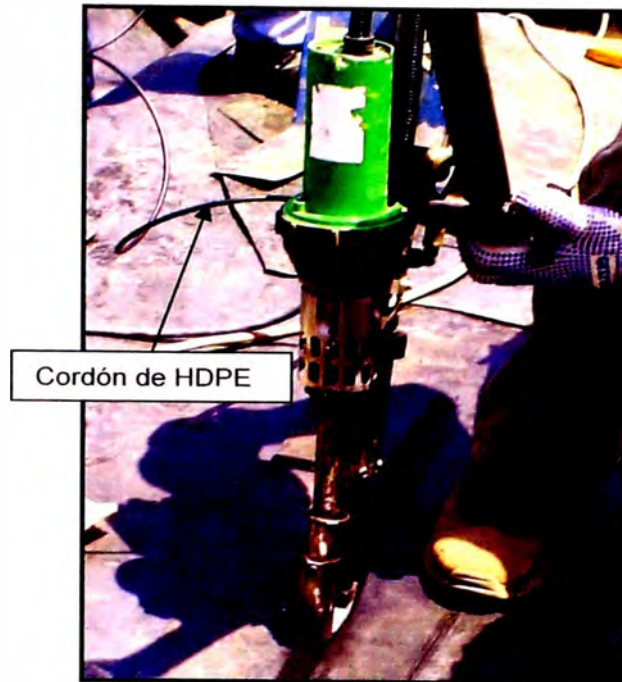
Soldadora por extrusión de material de aporte.
